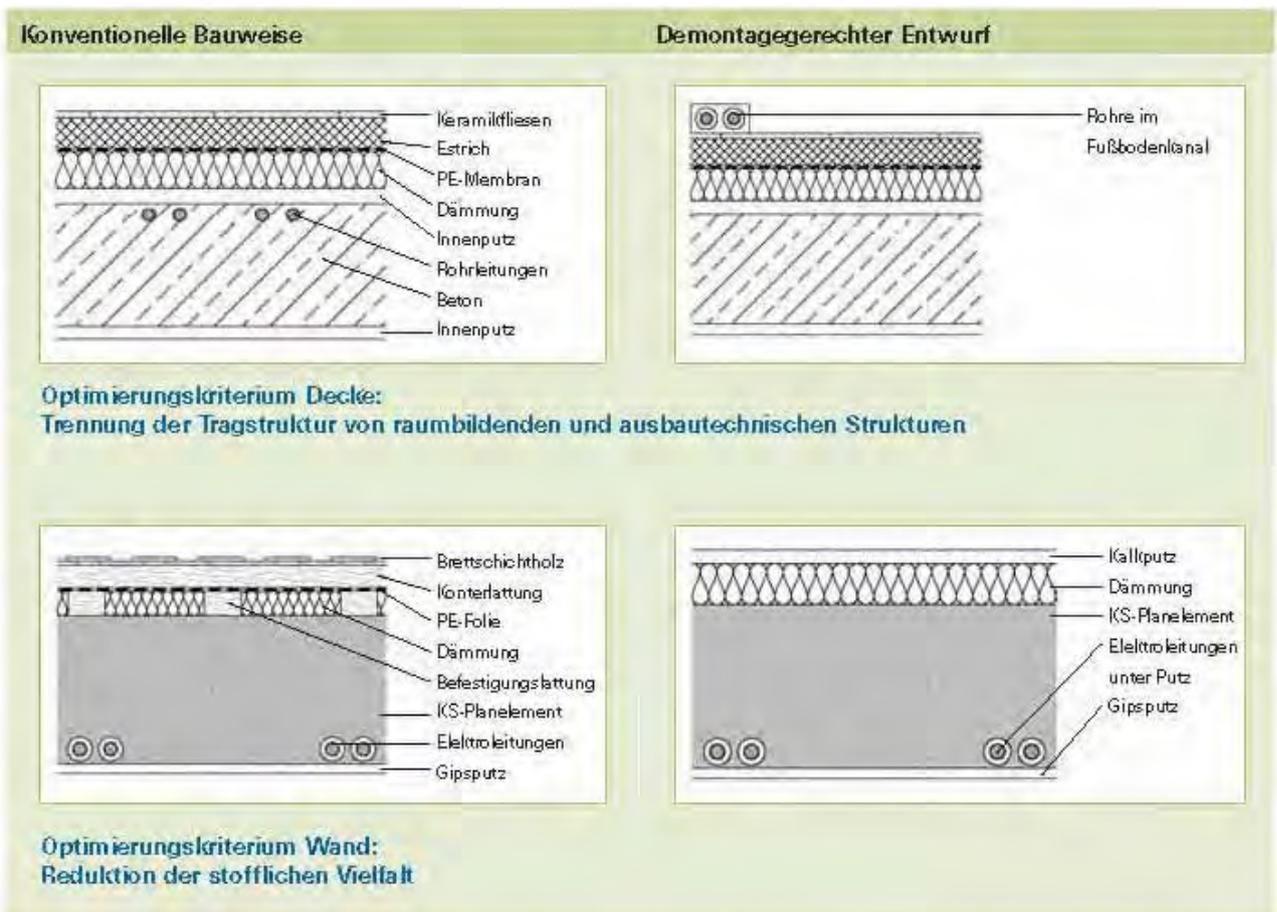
Recyclinggerechte und konventionelle Bauponstruktionen im Vergleich
